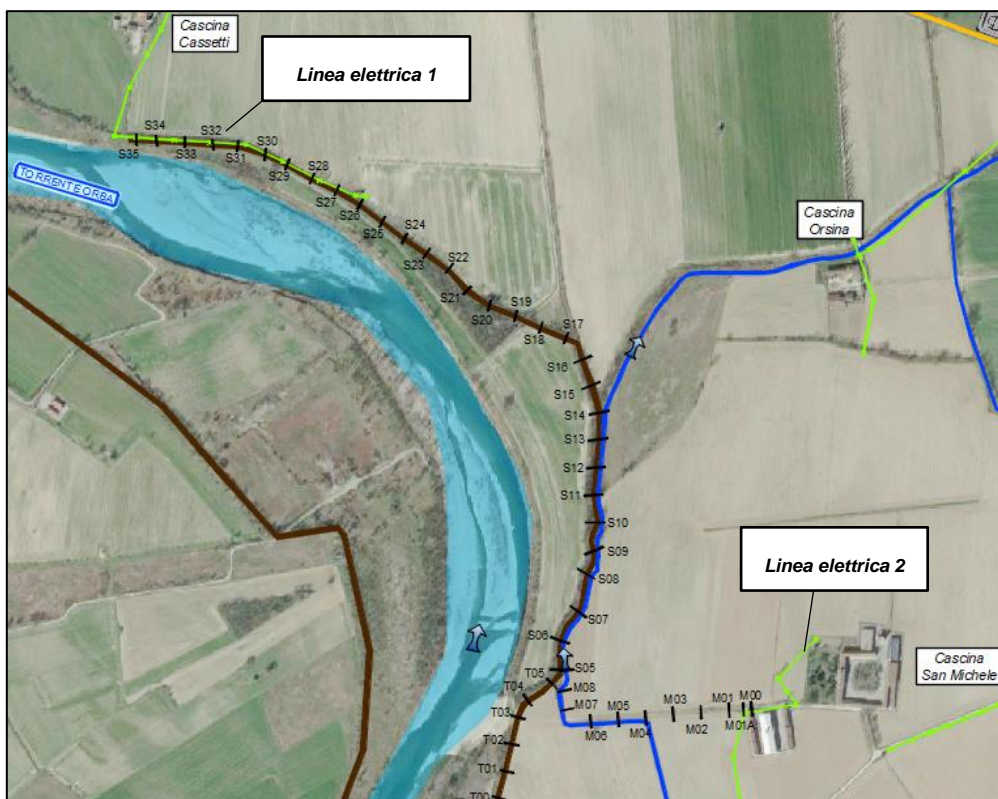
PLANIMETRIA INTERFERENZE LINEE ELETTRICHE (IN GIALLO)
